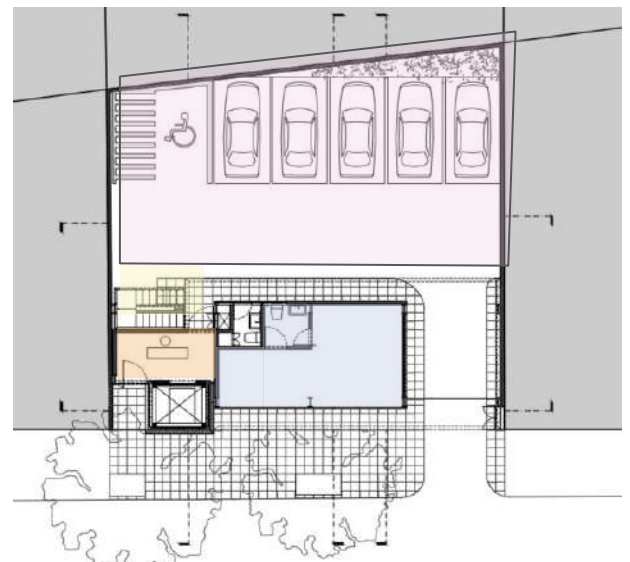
Plantas arquitectónicas de la Clínica Avenida Central.
